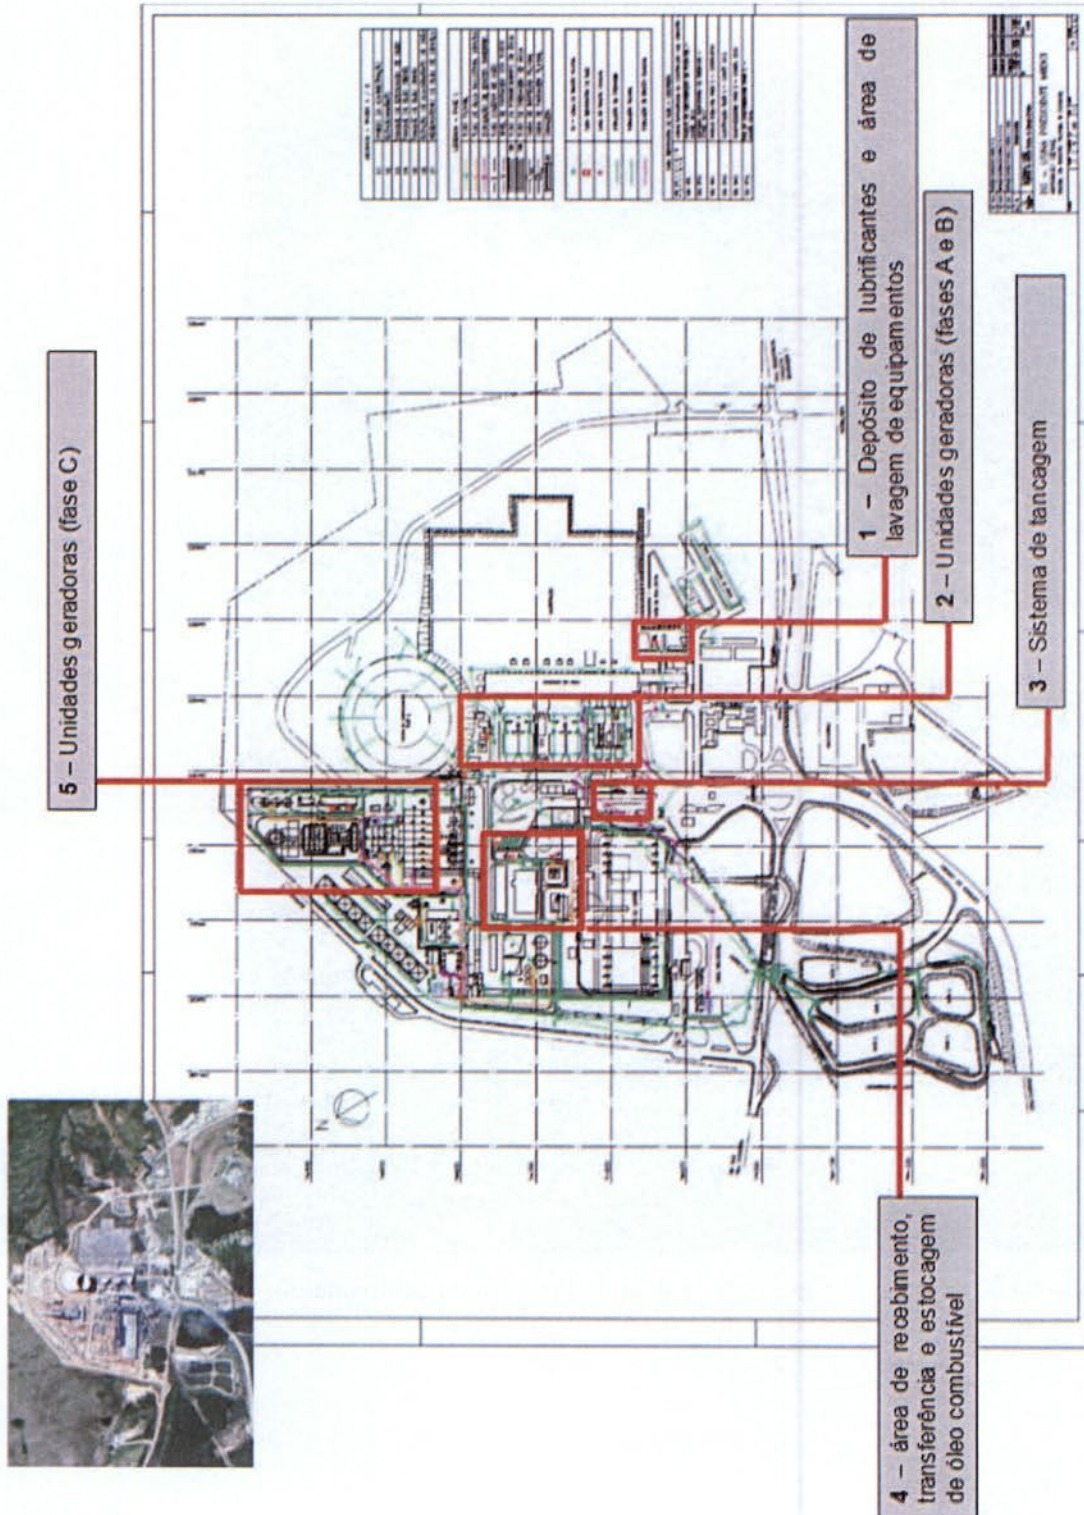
Planta de arranjo geral do complexo e identificação dos pontos vistoriados
